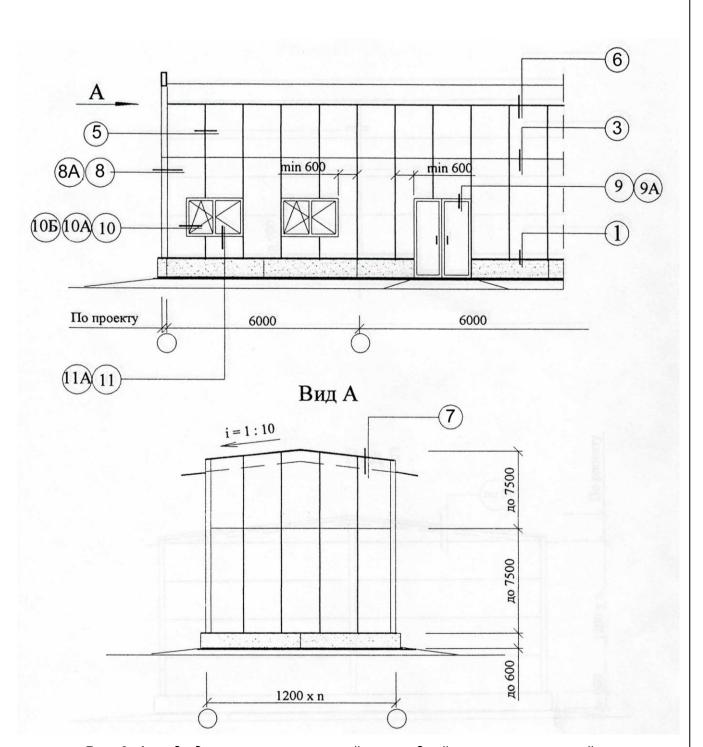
Фасад здания с вертикальной раскладкой стеновых панелей
